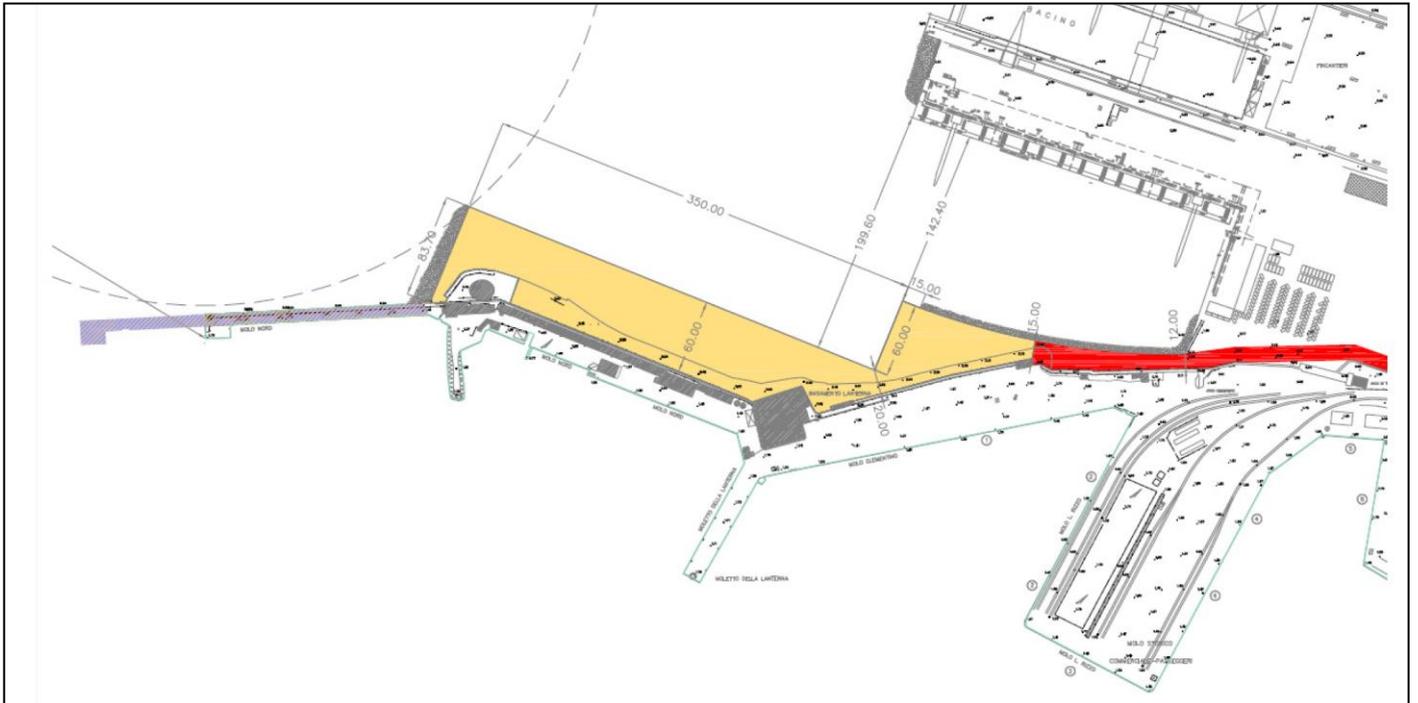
Planimetria generale di progetto SOLUZIONE 2 con risolto.
